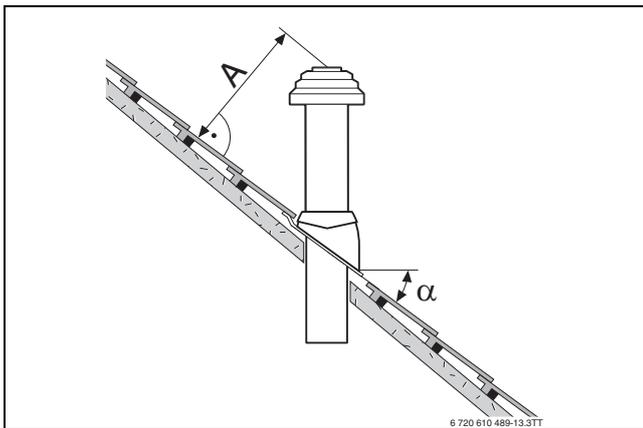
Abstandsmaße und Dachneigungen bei Schrägdach
